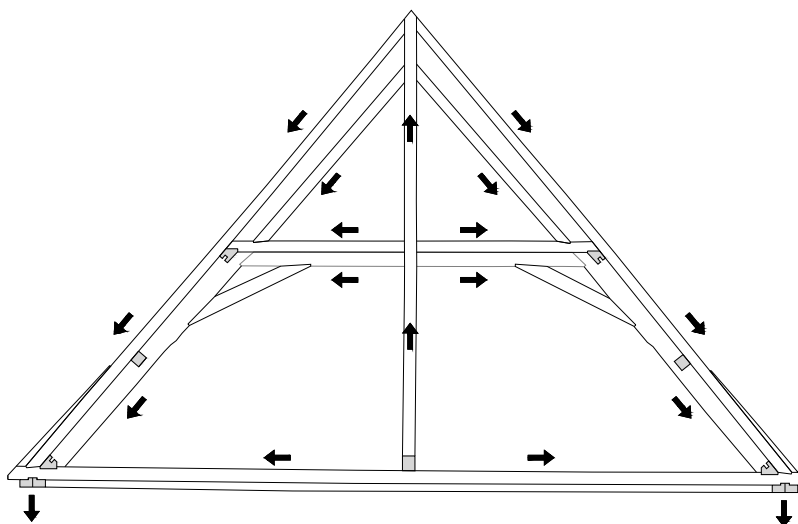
Lastabtragung nordwestliches Dachwerk
